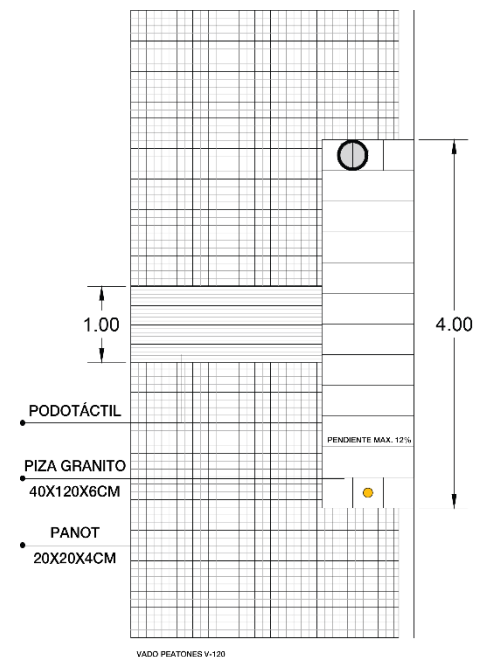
Detalle constructivo vado peatonal y rigola.
